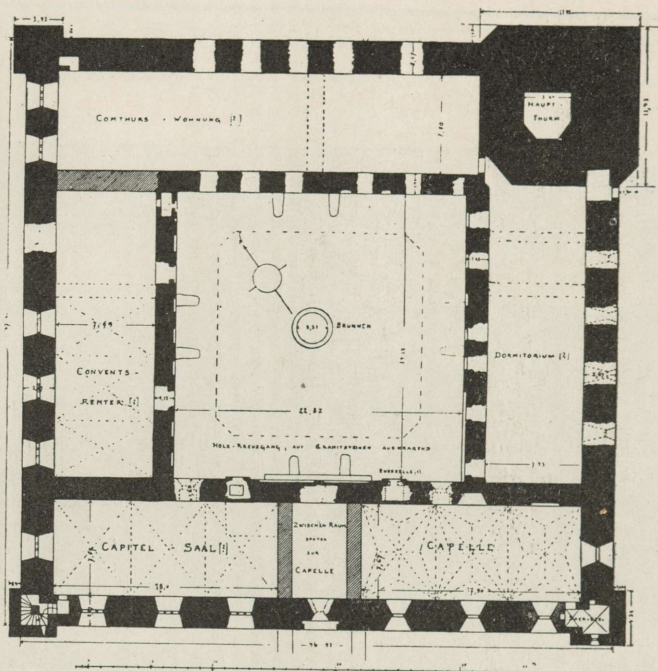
Mewe, Grundriss des Hauptgeschosses. Nach Steinbrecht.
